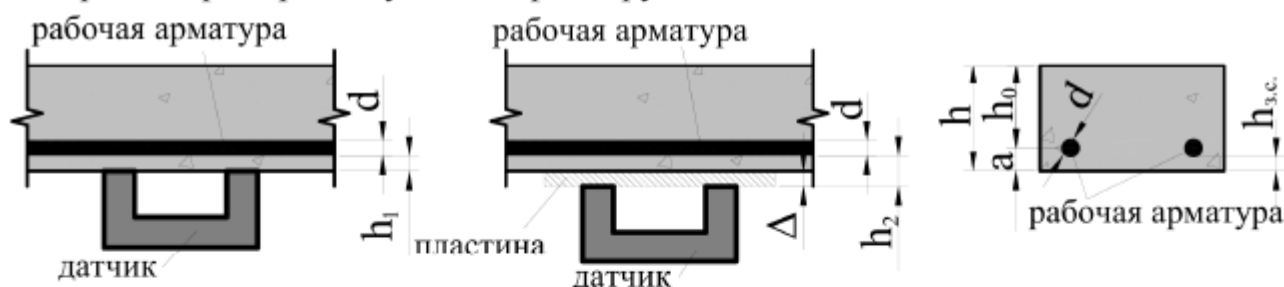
Схема определения диаметра арматуры и величины защитного слоя бетона железобетонной балки.
